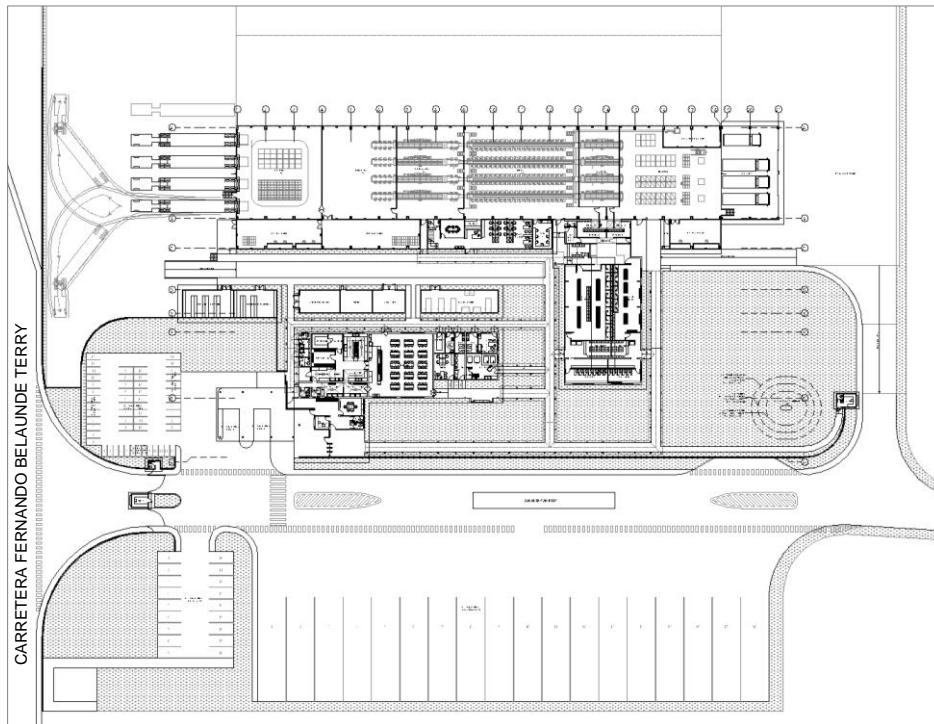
Planta de pelado y procesamiento de plátano – Plano general
